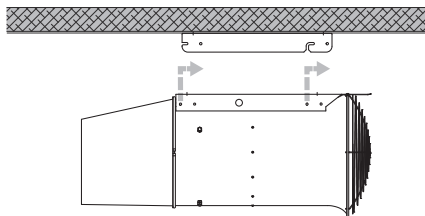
AZT: Voorbeeld van plafondinstallatie
